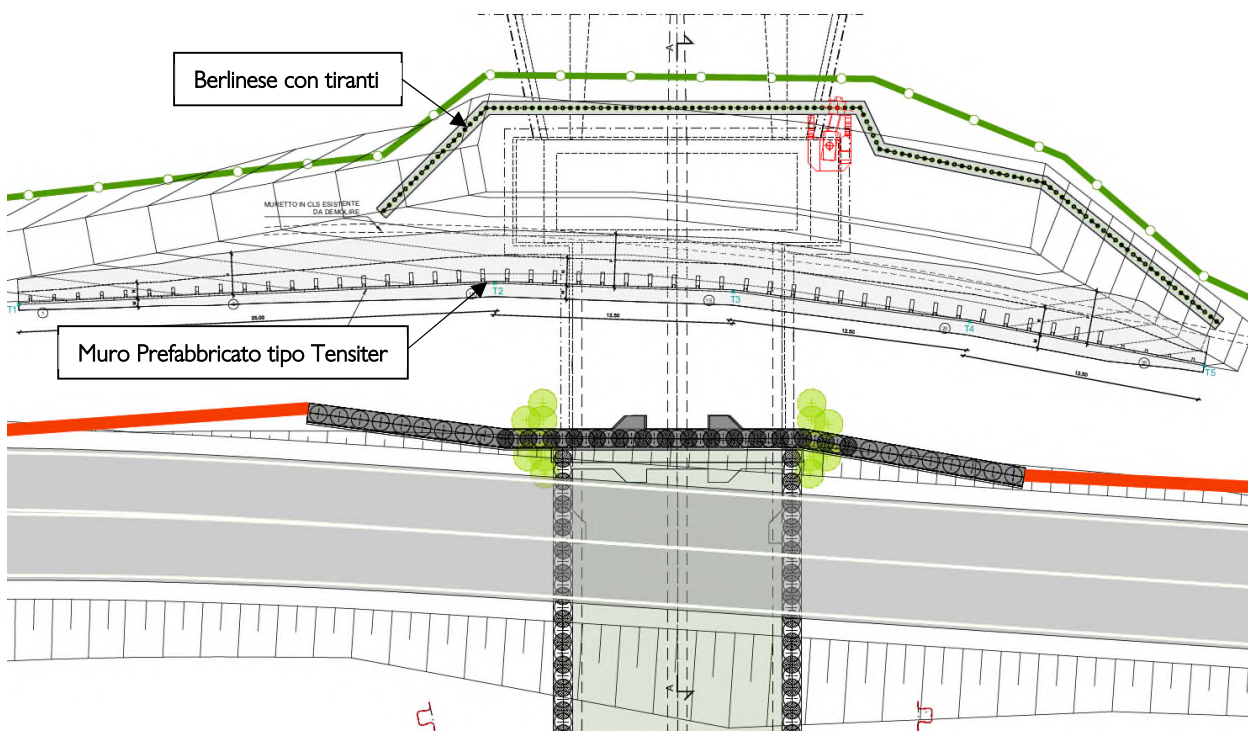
Planimetria di progetto – muri prefabbricati provvisori
